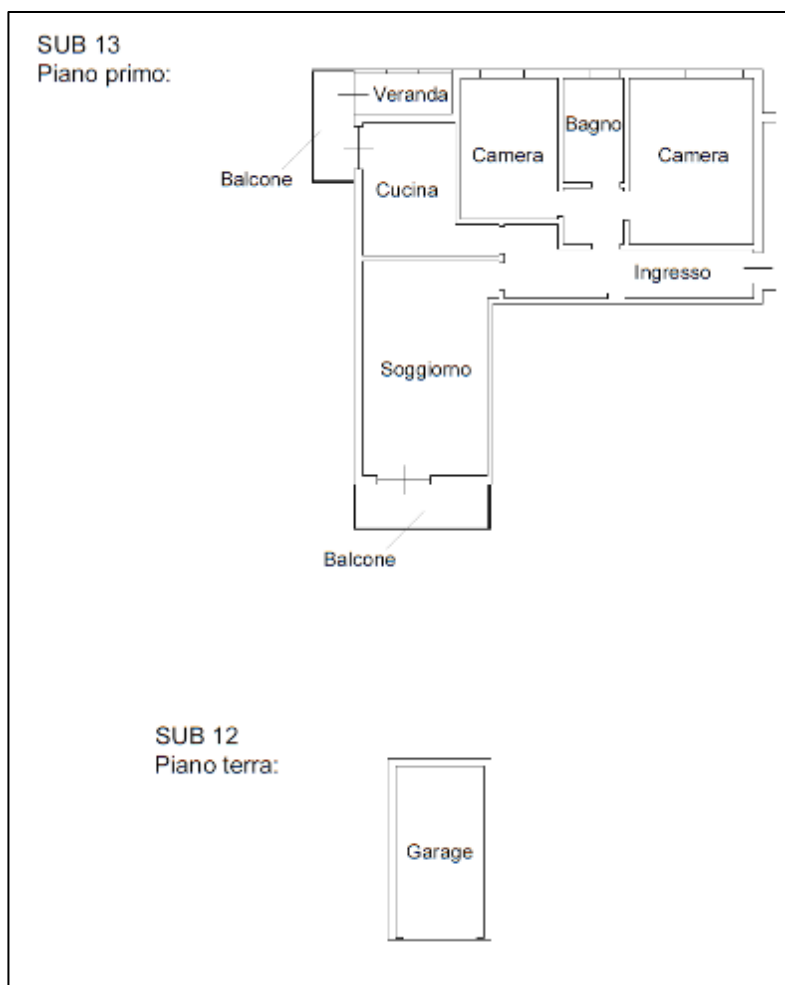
Schema planimetrico stato dei luoghi: fg. 78 m.n. 32 sub 12 e 13 (all 3)
